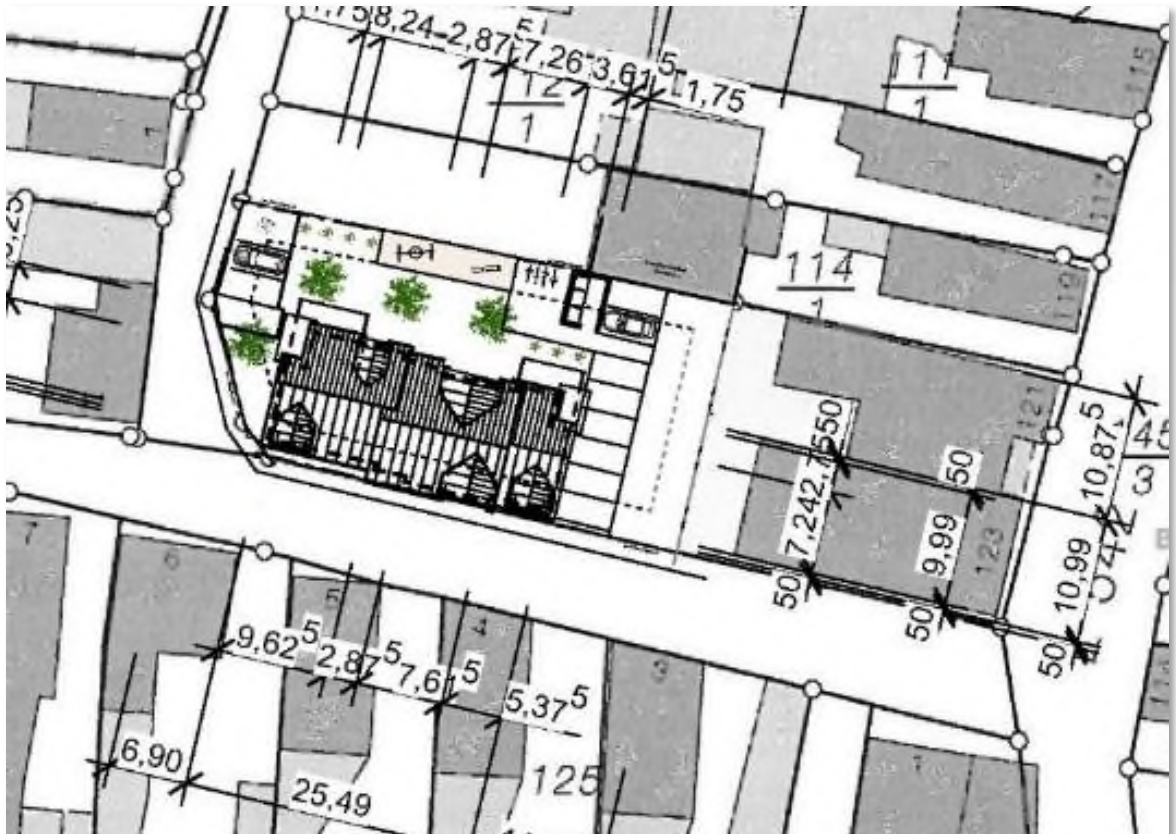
Lageplan geplante Wohnbebauung Änderungsbereich 1, freier Maßstab
